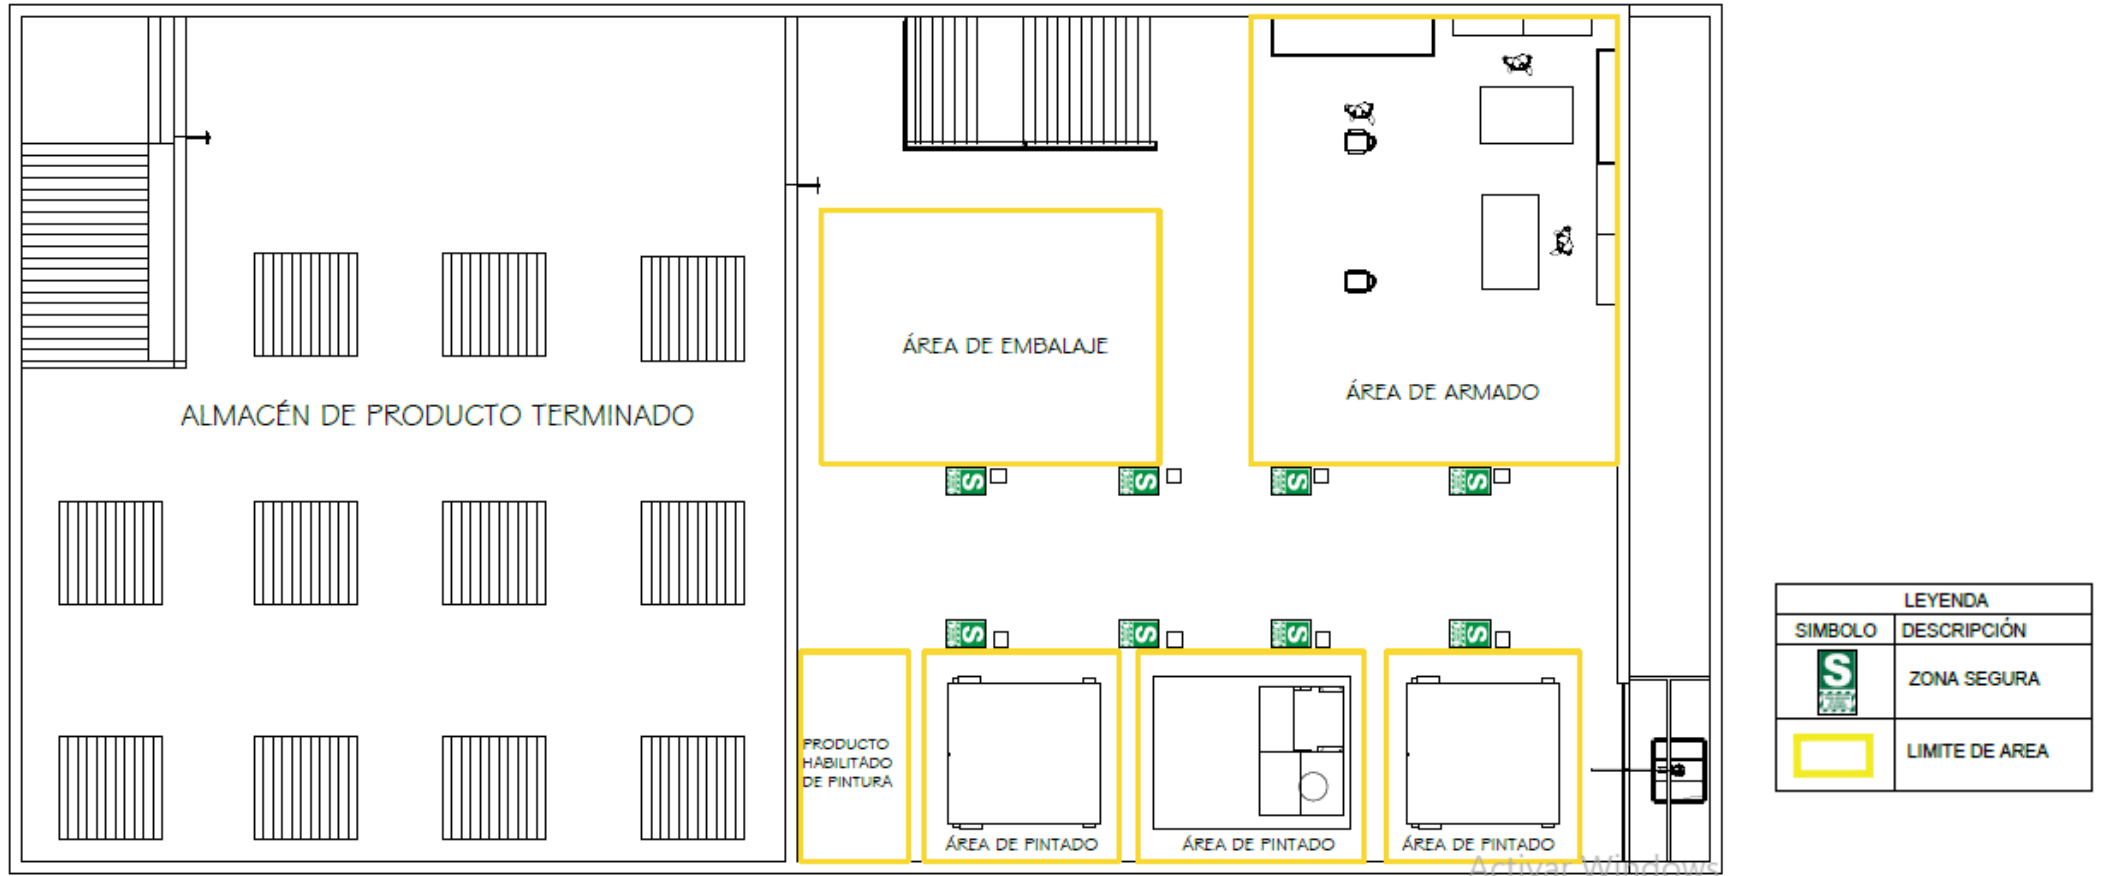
Layout de planta – segundo piso en Beramed EIRL
